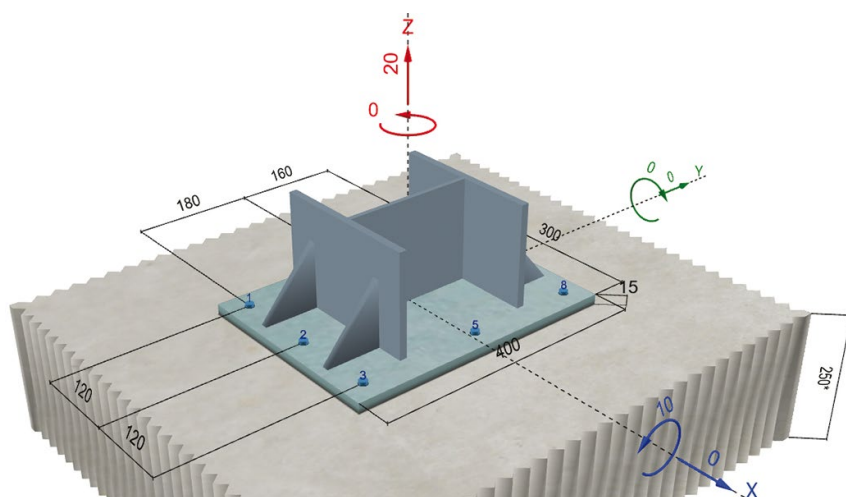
Stahlbauanschluss an Beton mit Versteifungen
